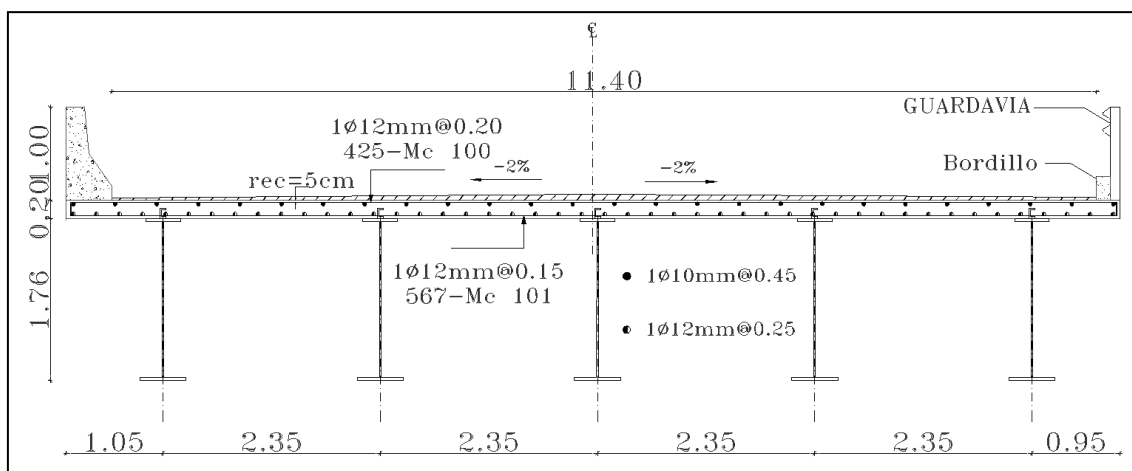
4: Armado transversal de Losa soportado con vigas de acero
